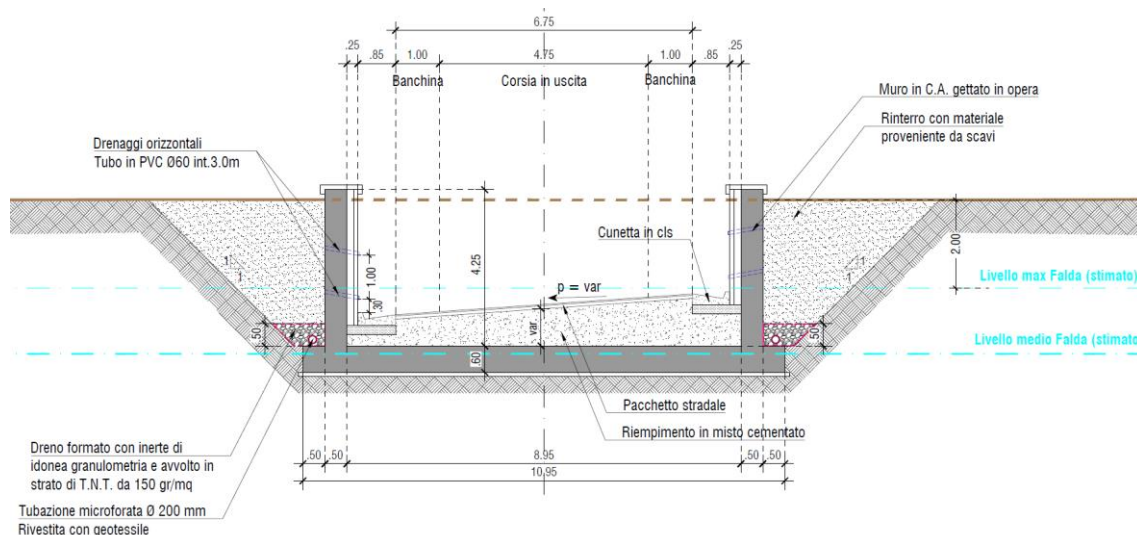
Sezione tipologica muro della rampa 1-U.
